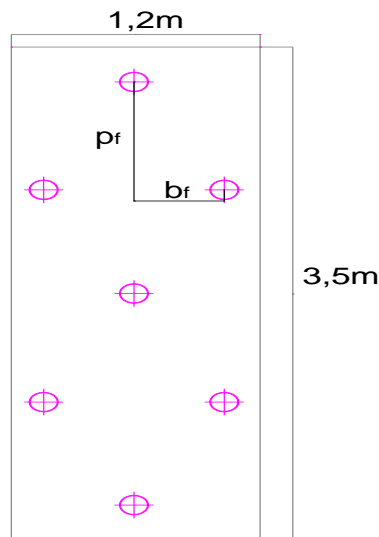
Emplacement des boulons (FIT) dans une section du tunnel T4
